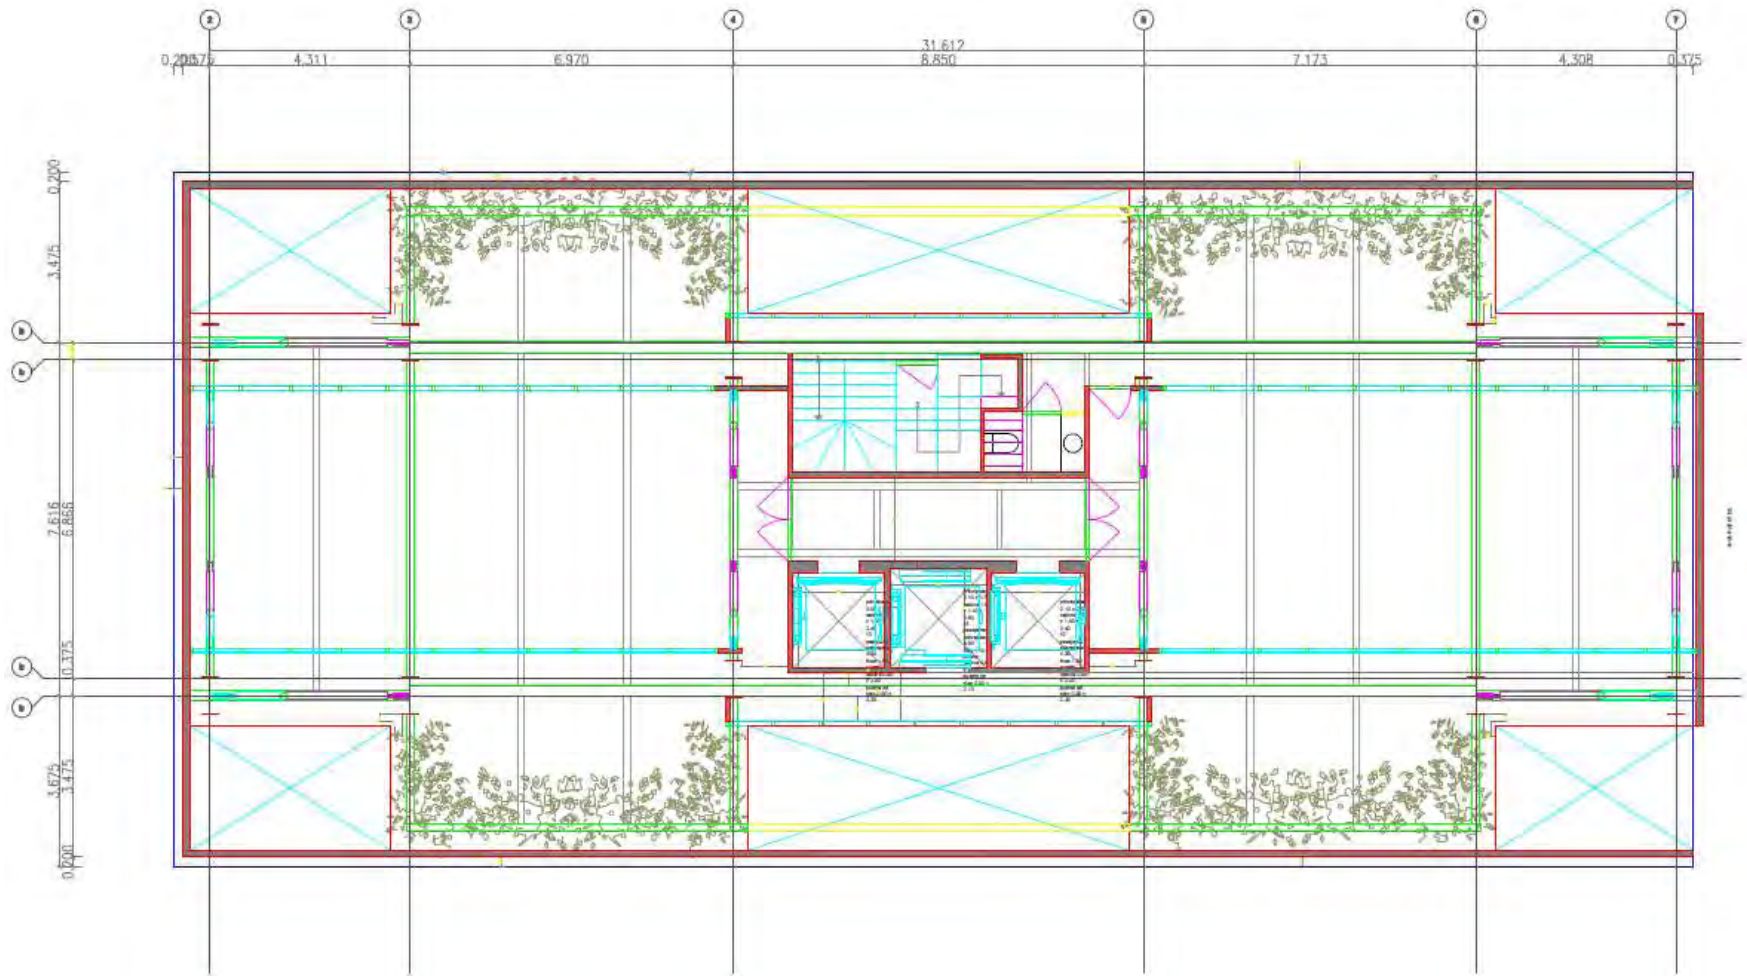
PLANTA TIPO SEXTO NIVEL (SKY LOBBY)
